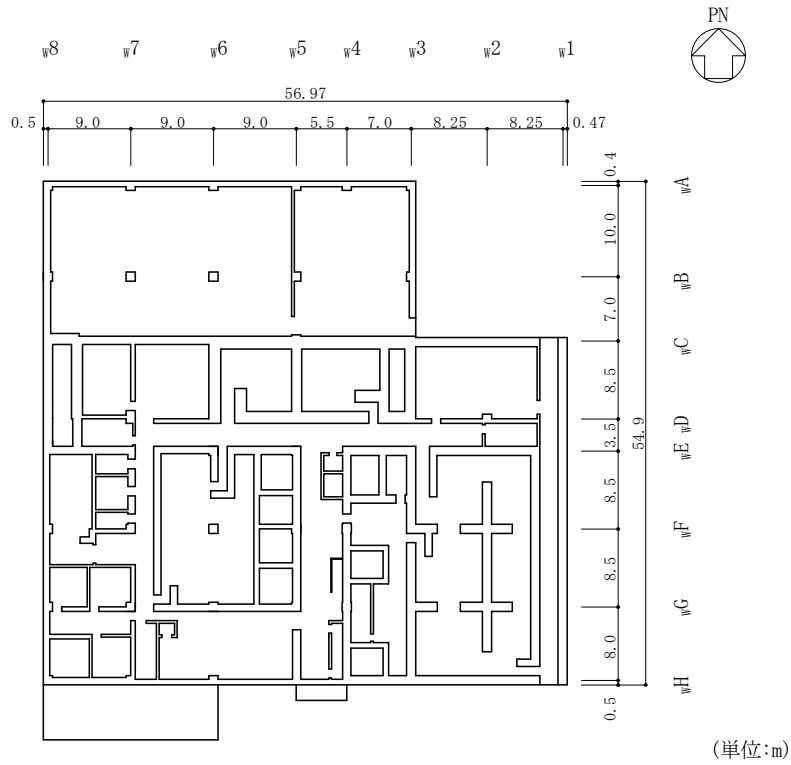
(5) 廃棄物処理建物の概略平面図 (EL 22.1m)
